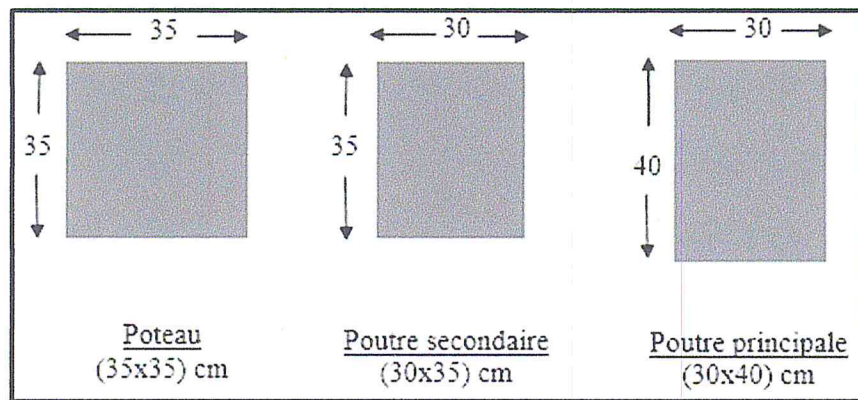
Dimensions des poteaux et des poutres du bâtiment.
